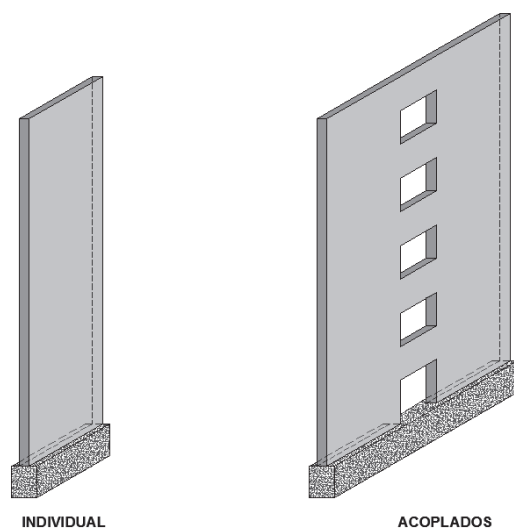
FORMA EN PLANTA – MUROS ESTRUCTURALES
